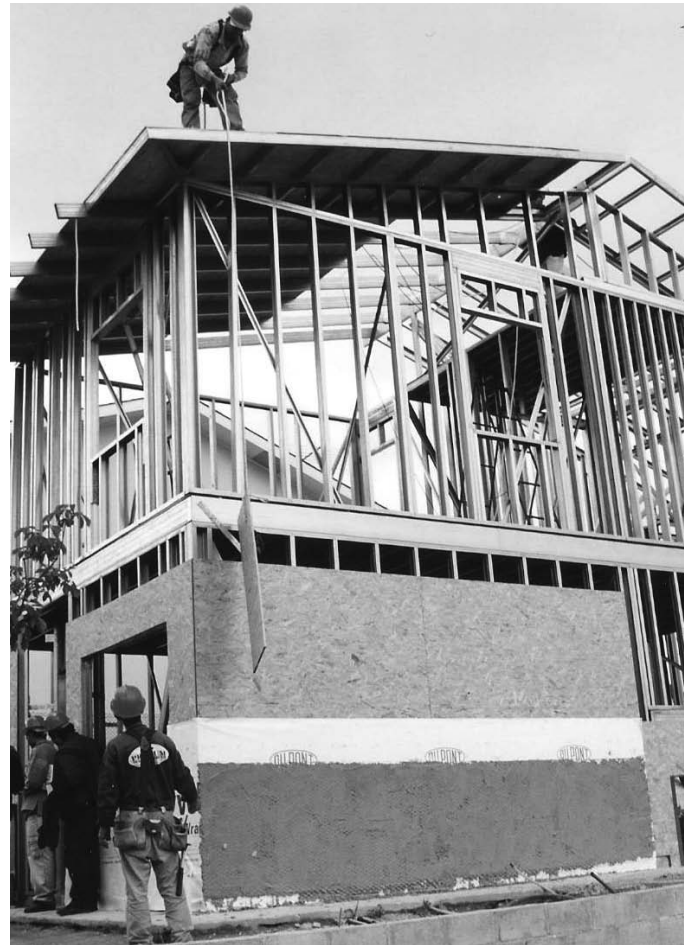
Instalación de placas de OSB sobre el techo (Fuente: Archivo del autor)
